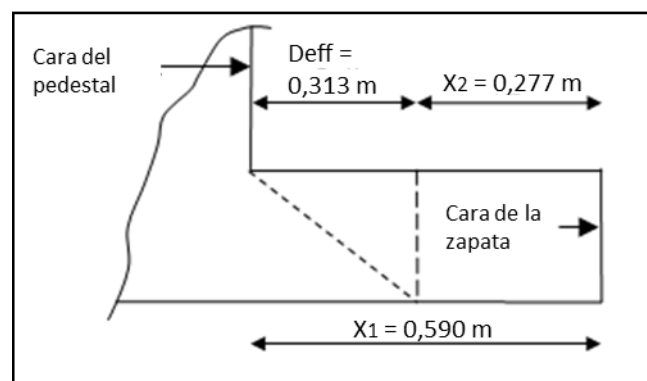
Corte representativo de la fundación. Fuente: STAAD Foundation Advanced.
